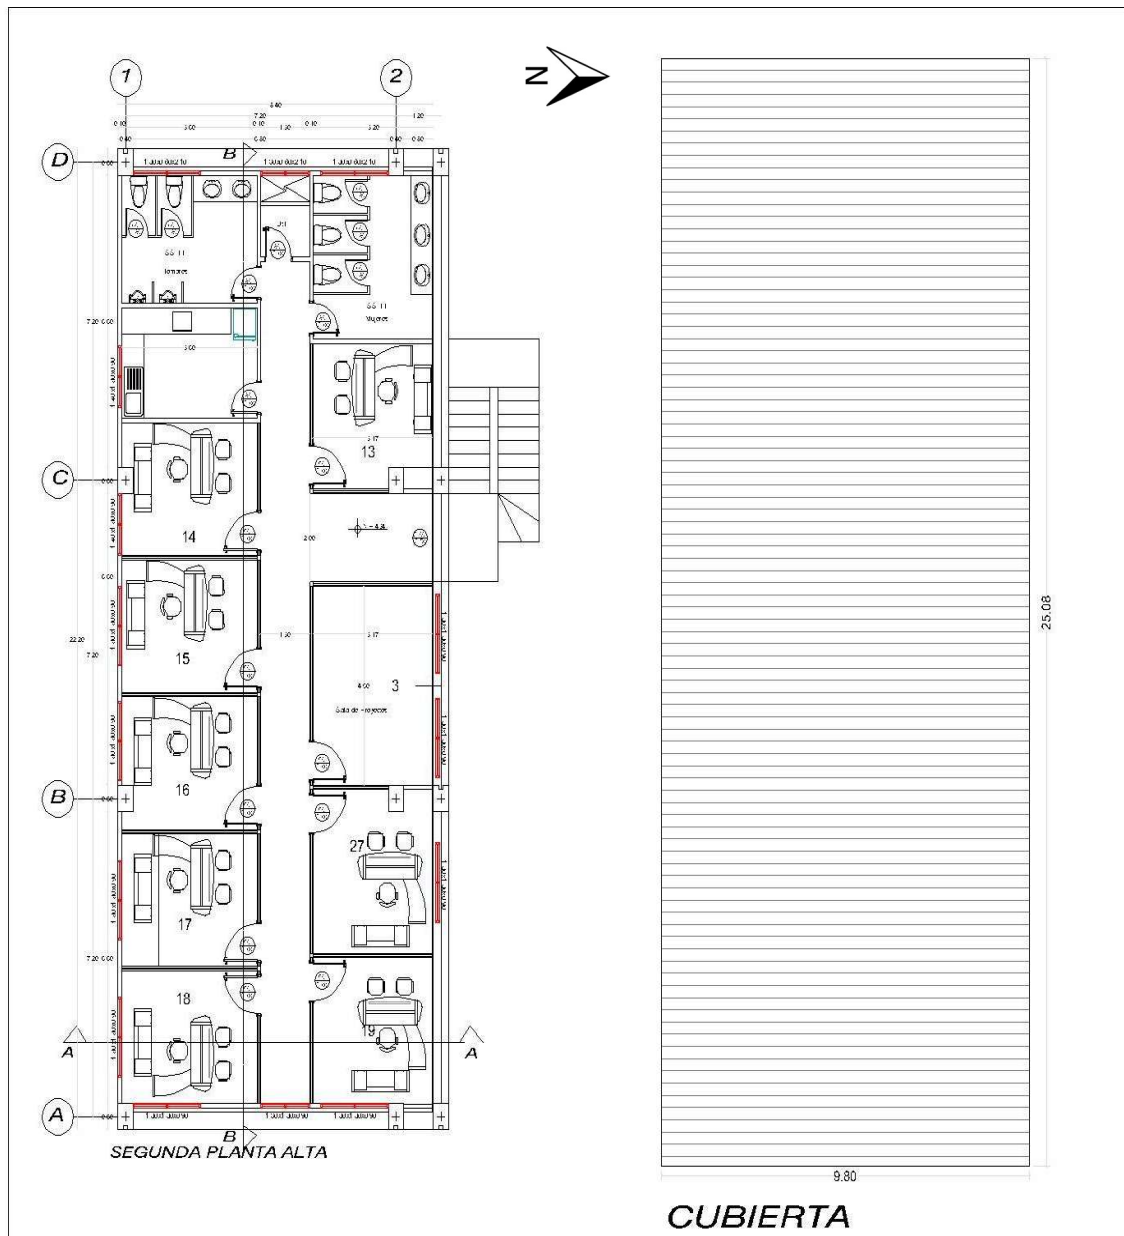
Planos arquitectónicos base de la segunda planta y cubierta.
